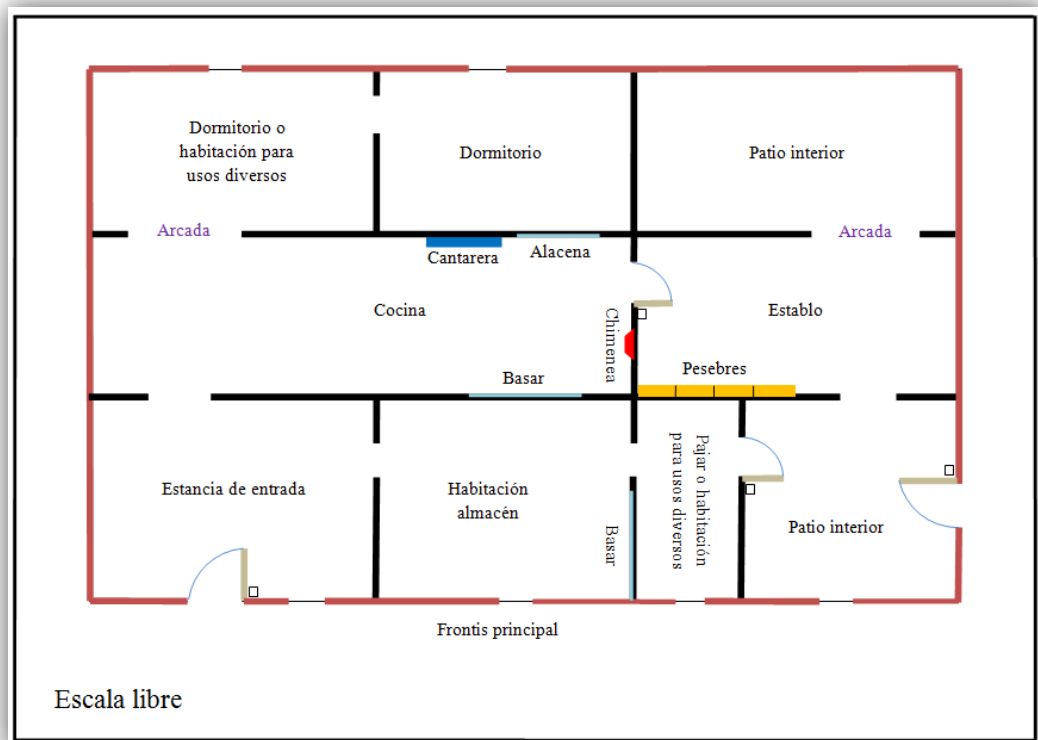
planta de un cortijo tipo tradicional de una sola planta, en el Campo de Níjar (Almería). Los muros externos y las paredes internas se construían con gruesas piedras cementadas por adobe (barro). El techo se construía con vigas de madera que soportaba un entramado de cañas cubierto por tierra launa (filitas)
